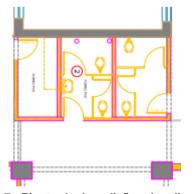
Planta de demolição - localização no Banheiro existente (2ºpavimento)
